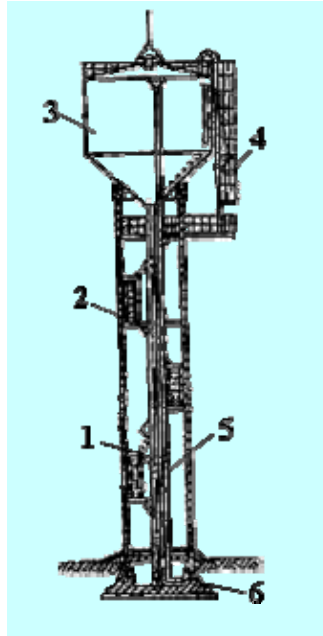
Proiect tip castel de apă din beton armat 300 m<sup>3</sup> cu înălțimea turnului de 21, 24, 30, 36 și 42 m
